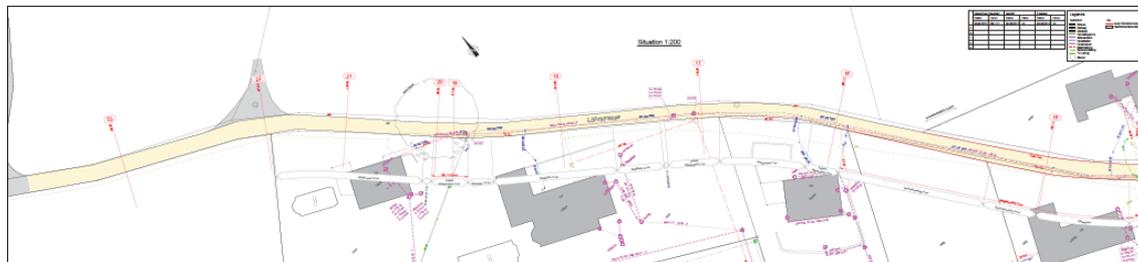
Situationsplan 2 des Bauprojekts, oberer Strassenabschnitt (Stand: Sept. 2012)
